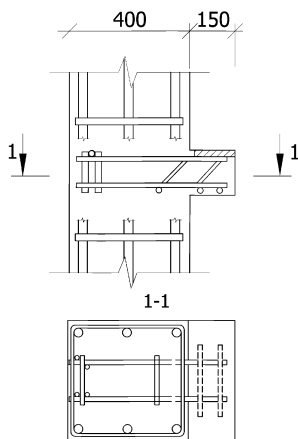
Армирование консоли колонн при шарнирном опирании ригеля
